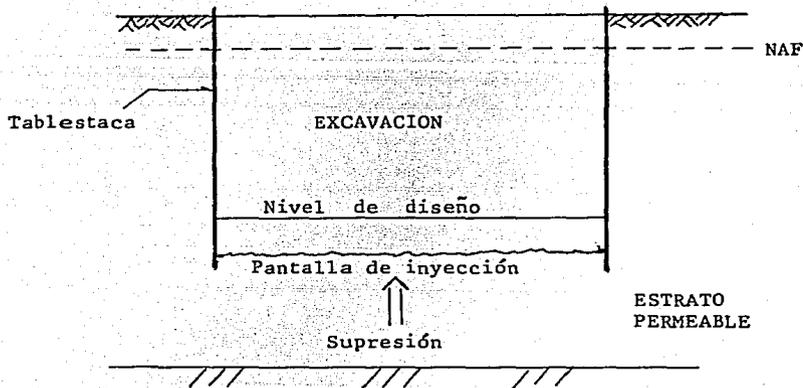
PANTALLA DE INYECCION HORIZONTAL.
